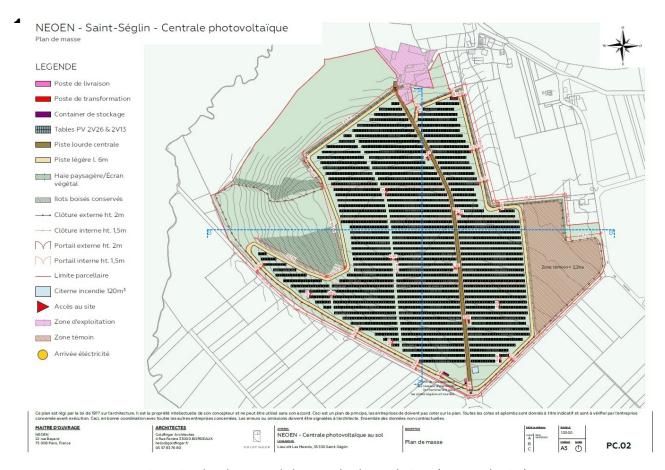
Plan de masse de la centrale photovoltaïque (source : dossier)
